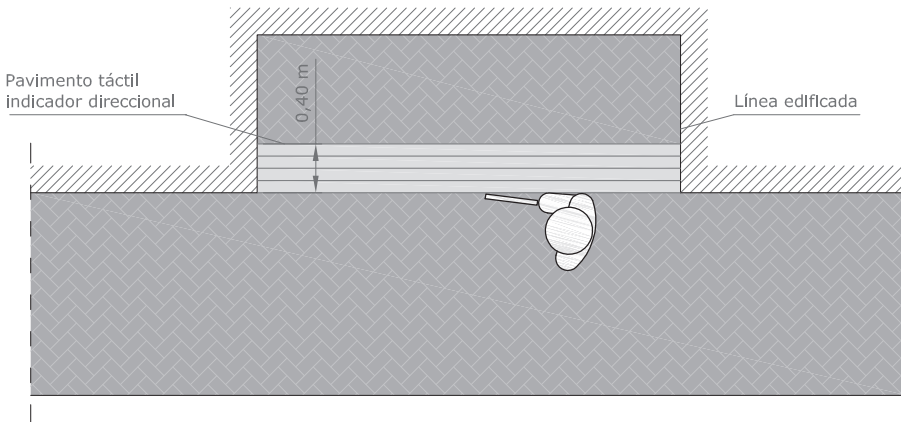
Encaminamiento junto a línea de fachada en un itinerario accesible.
